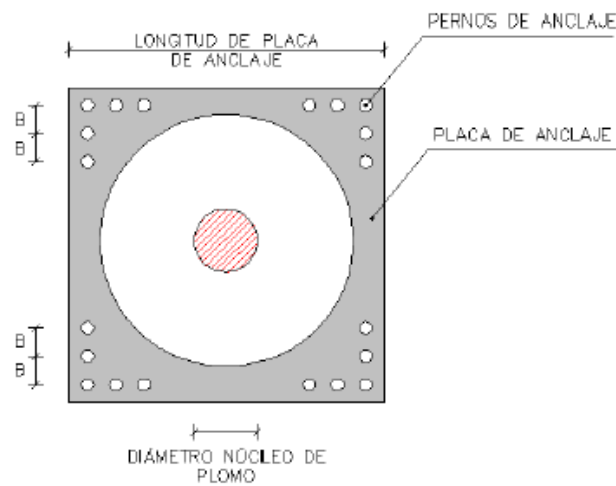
Detalle del aislador con núcleo de plomo visto en planta.
